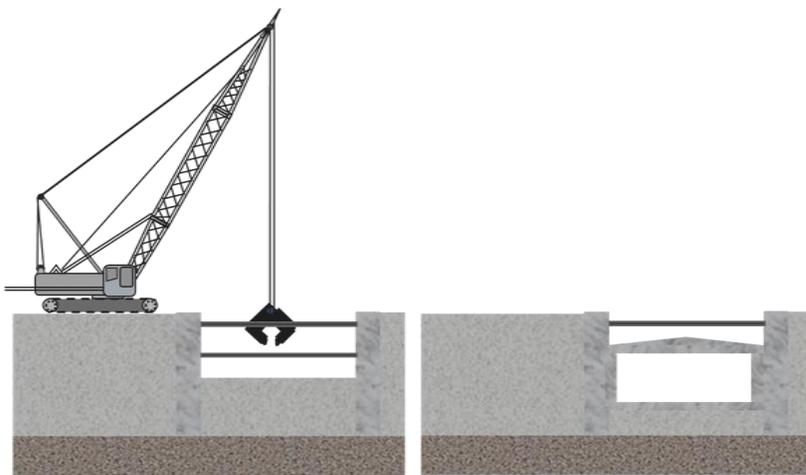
; Excavación del núcleo y fabricación de losa, muros y tabletas.
